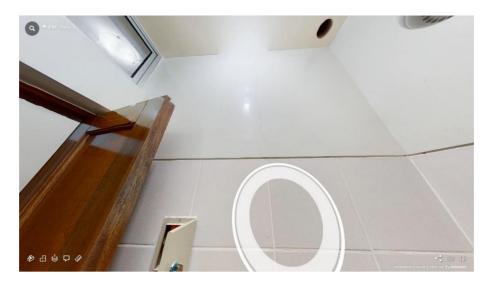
Cuarto de Curados (Pared con Fisuras)
